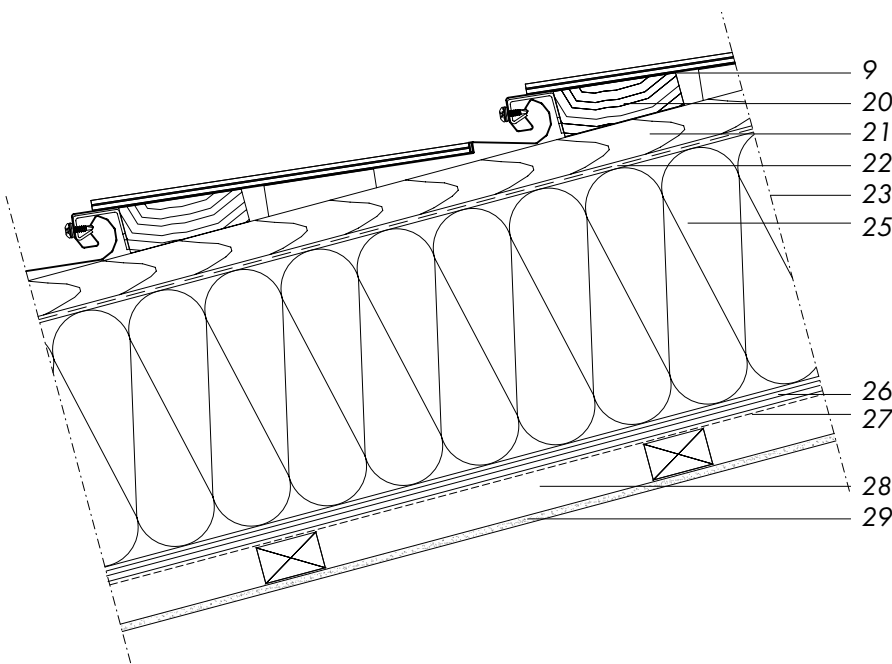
Konstruktionsbeschreibung Dachaufbau
